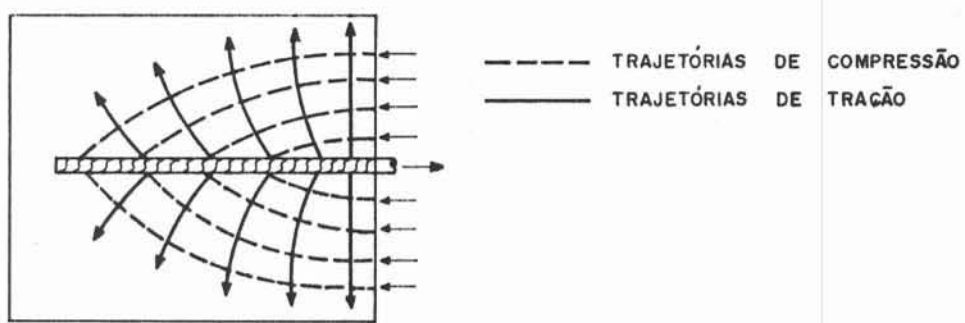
Desenvolvimento das trajetórias das tensões principais na zona de ancoragem de uma barra de armadura.
